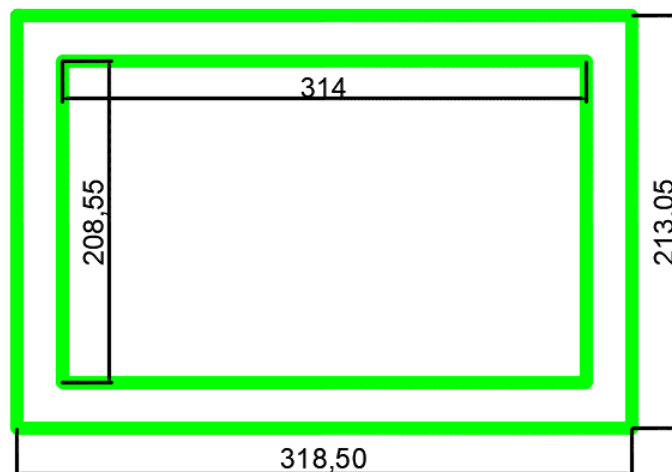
Vista en planta laguna de maduración de 1,50 m de profundidad.
